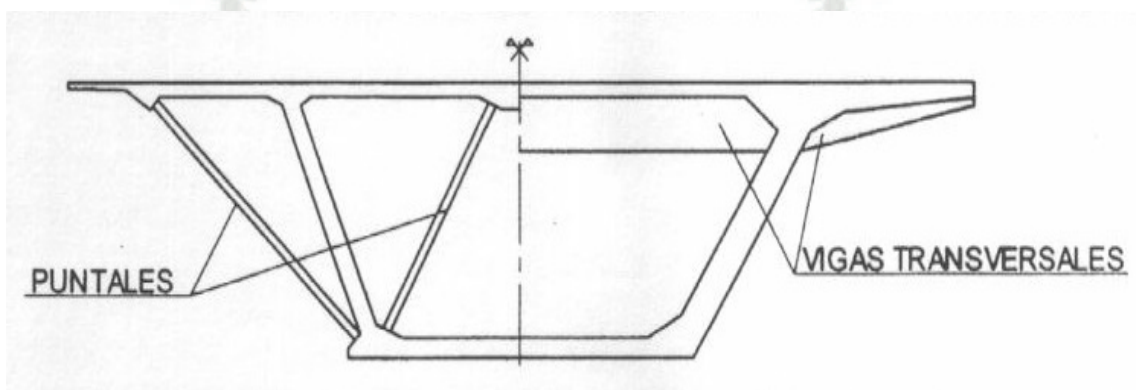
Sección cajón estabilizada por puntales metálicos o traviesas. (Fuente: Ministerio de Fomento 2000)
